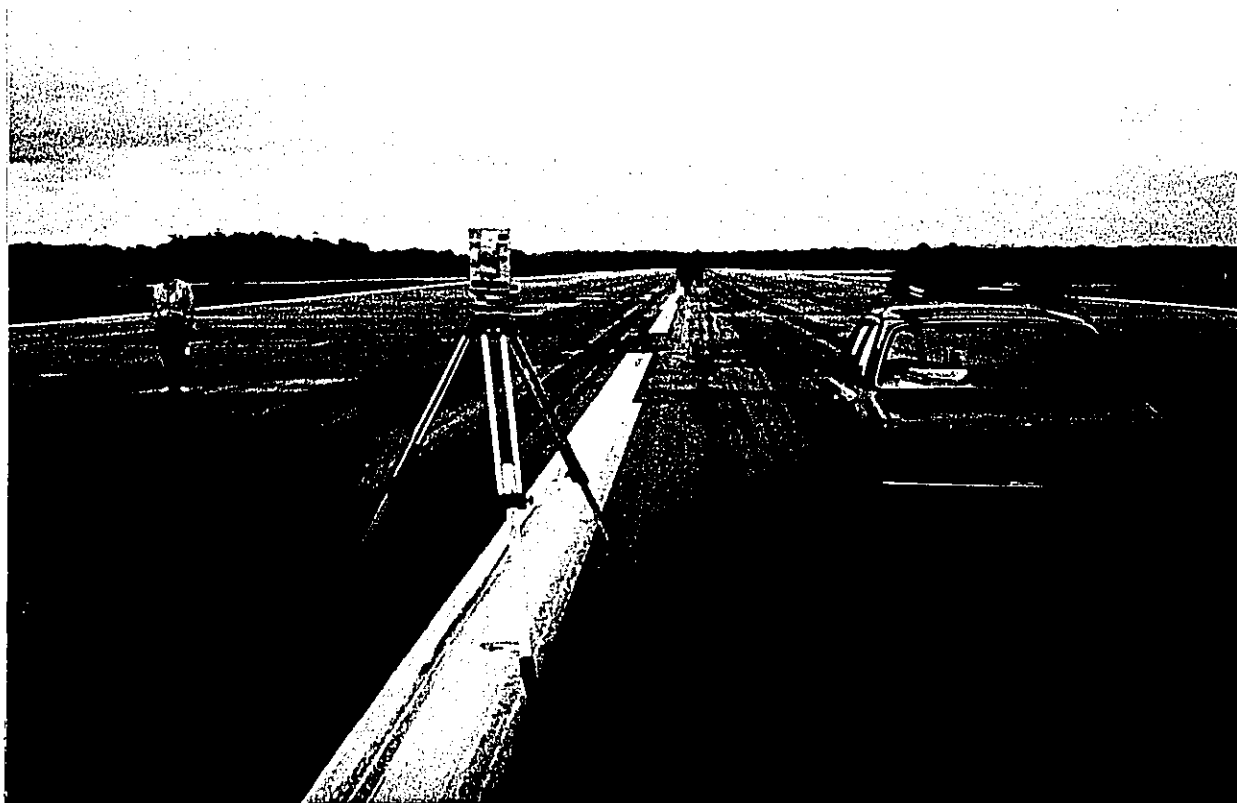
DETERMINACION DEL EJE - PISTA 01/19
